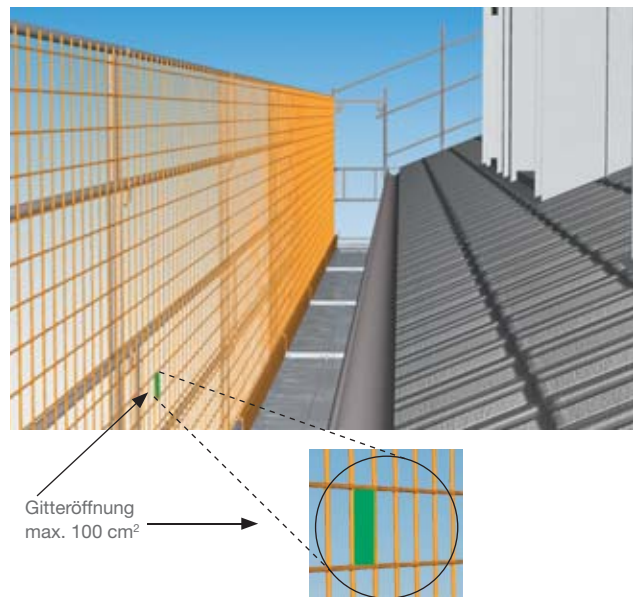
Spenglergang mit Dachdeckerschutzwand, Variante mit Gitter über die gesamte Höhe
